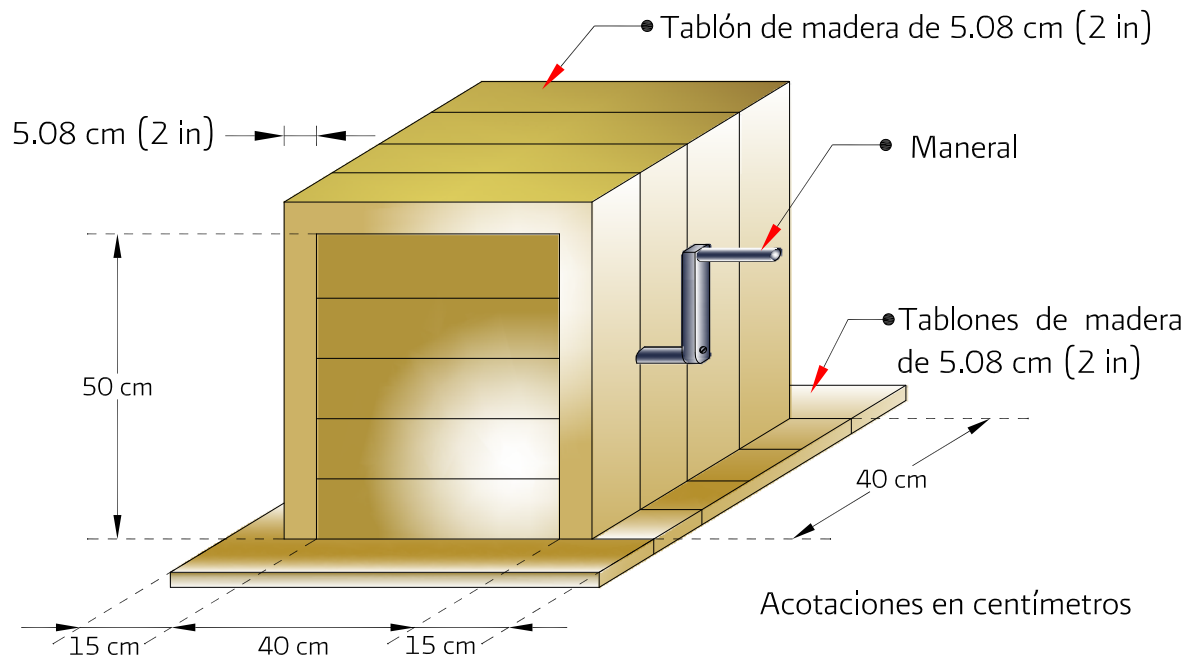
Caja de protección para inclinómetros en sobreelevación por debajo de las terracerías
